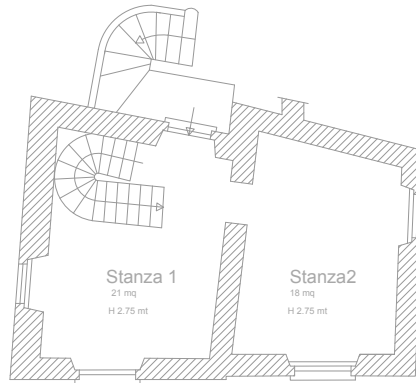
Sub 3 piano secondo _ Scala in ferro per accedere al sottotetto
